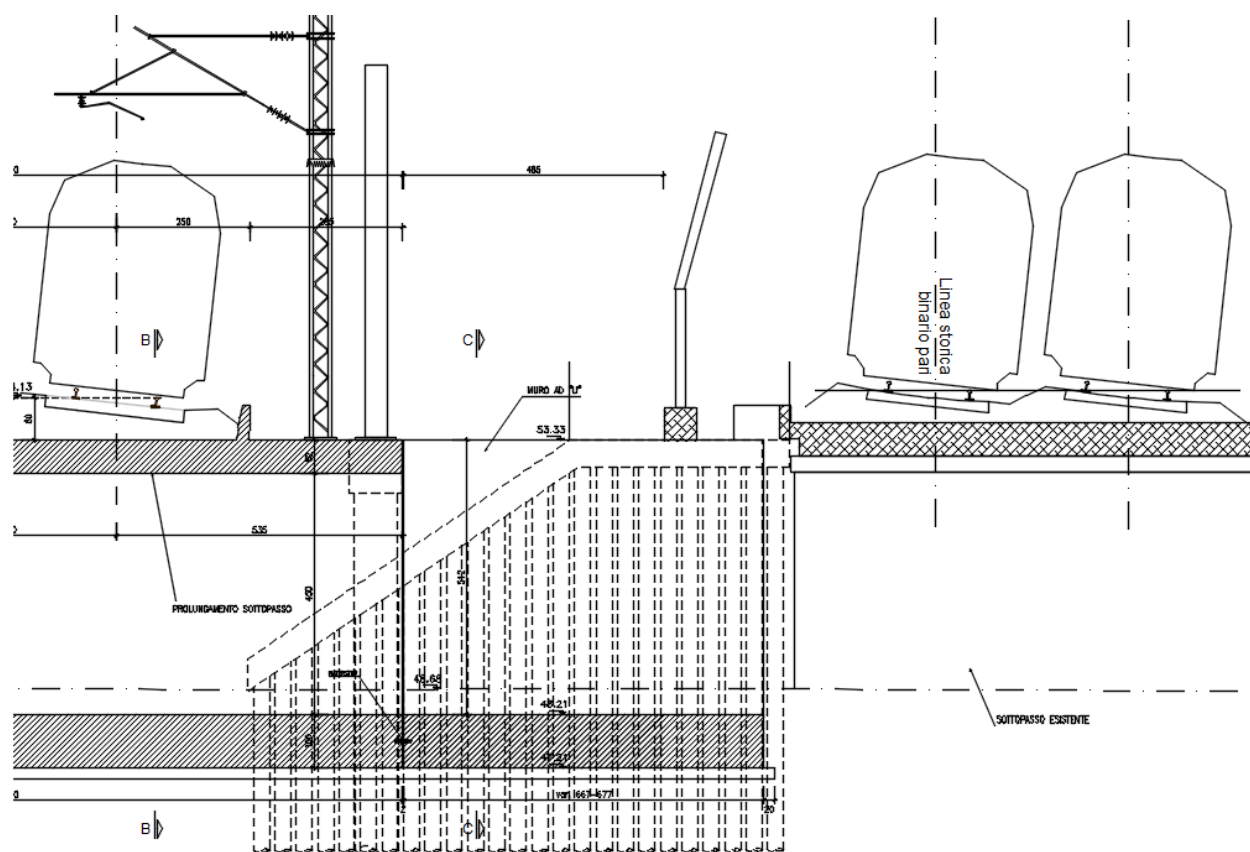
Prospetto longitudinale del muro ad "U" di imbocco del sottovia SL02
